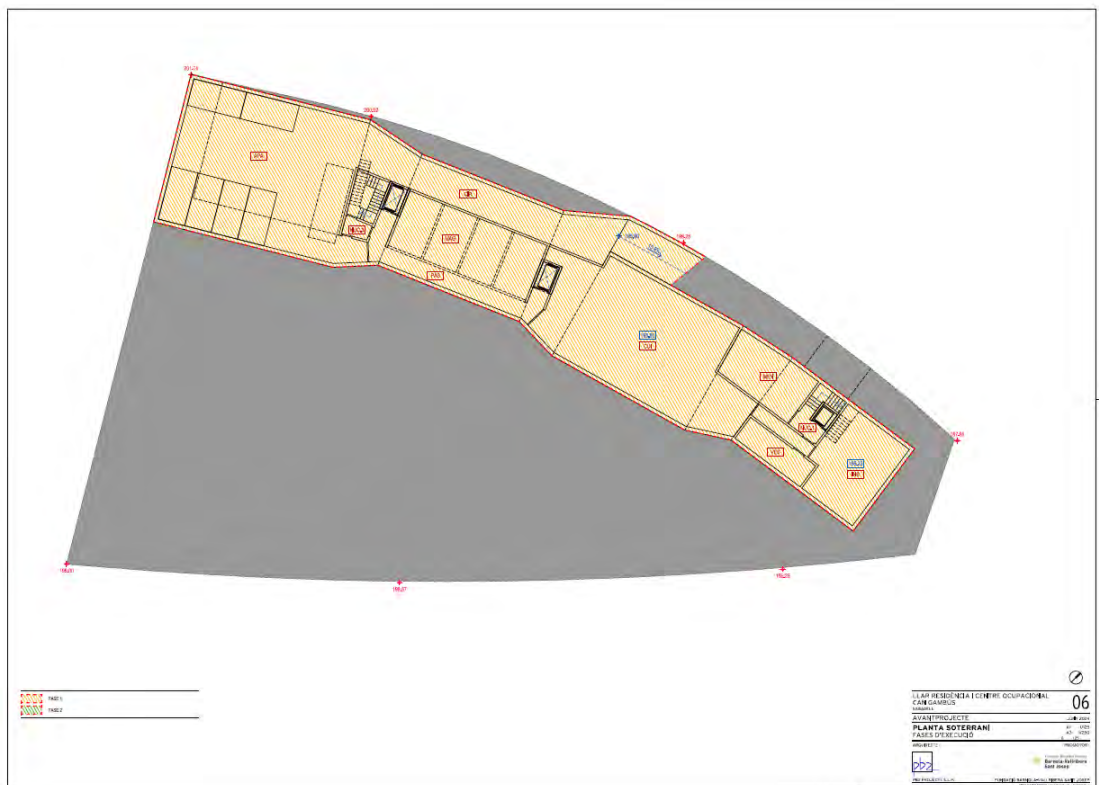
Fases d'execució: Plànol 06. Planta soterrani. Fase 1, en groc.
